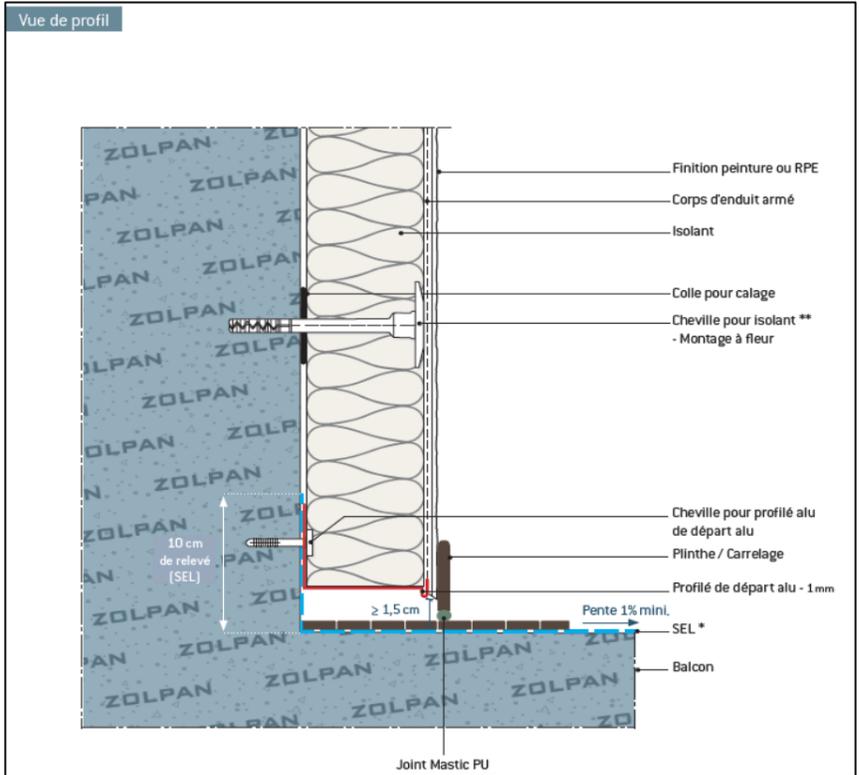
système Traitement de départ sur balcon avec étanchéité et revêtement carrelage source www.zolpan.com
